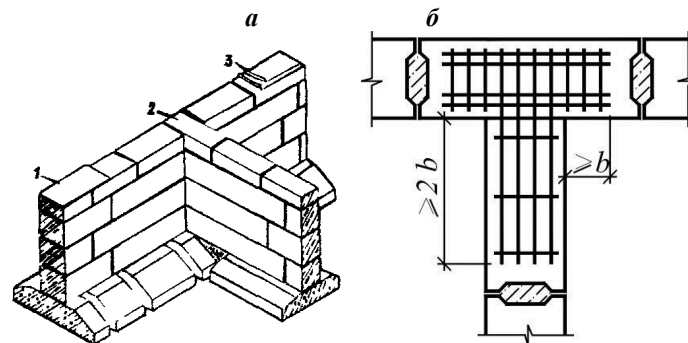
Перевязка блоков продольных и поперечных стен подвала: *a* – перевязка блоков; *б* – усиление примыкания арматурными сетками; *1* – выровненная поверхность стены подвала; *2* – перевязка блоков; *3* – гидроизоляция.
